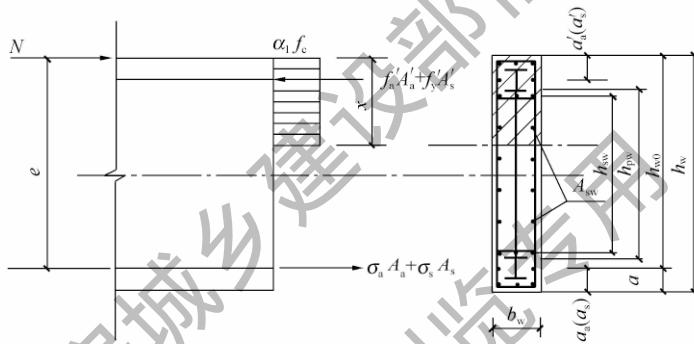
钢板混凝土偏心受压剪力墙正截面受压承载力计算参数示意
